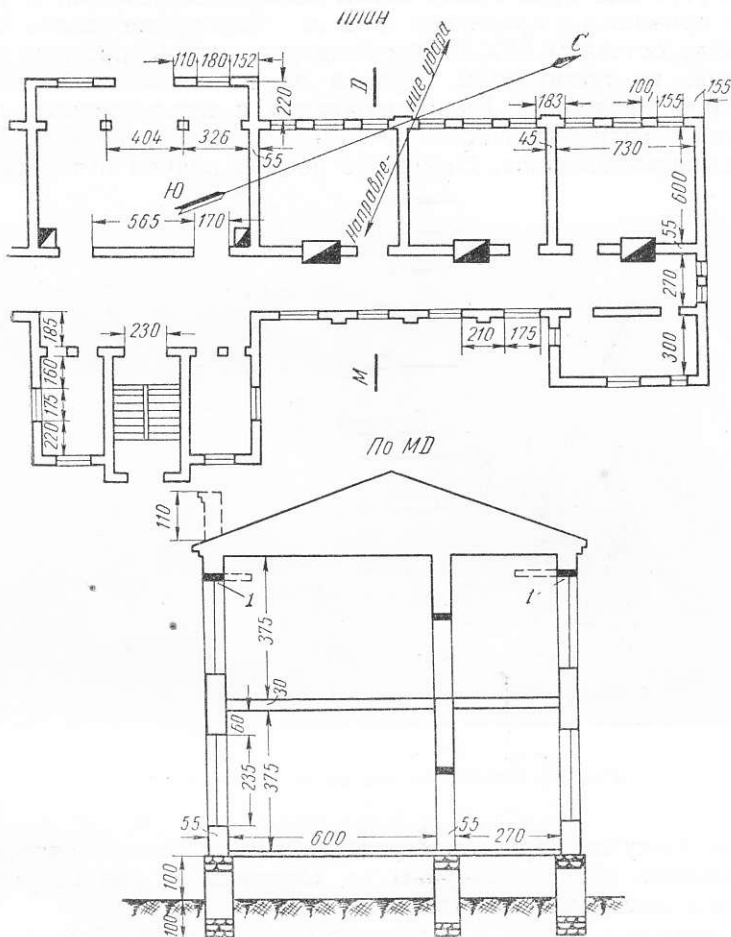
План 1-го этажа и разрез здания школы по улице Островского
